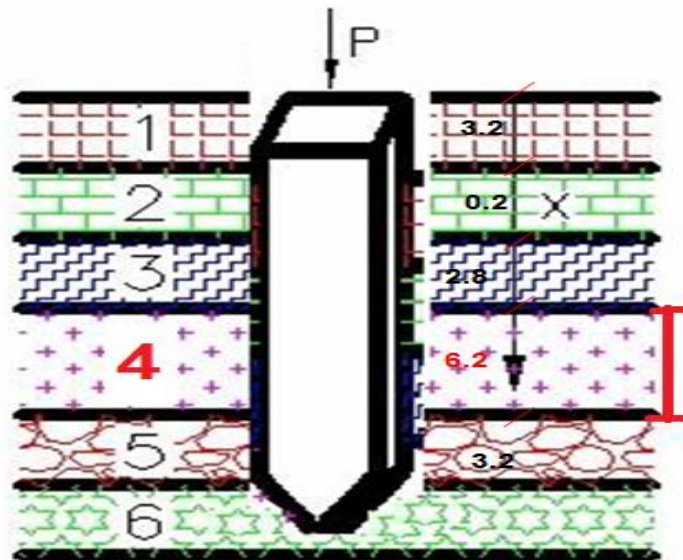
Detalle del perfil del suelo que soporta la cimentación.
